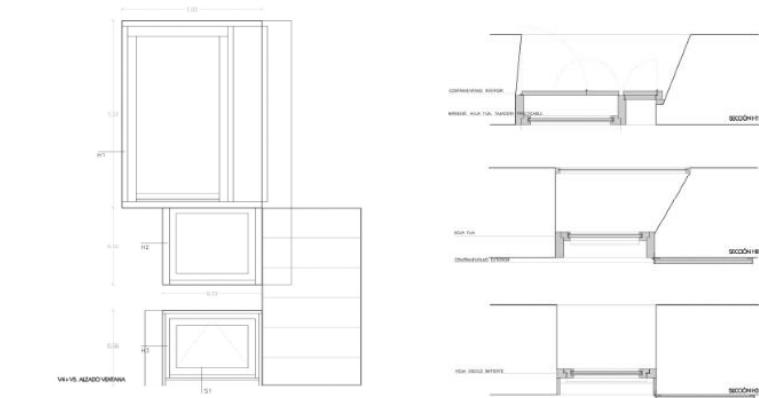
Construcción de las carpinterías [Congrés d'Arquitectura 2016]
